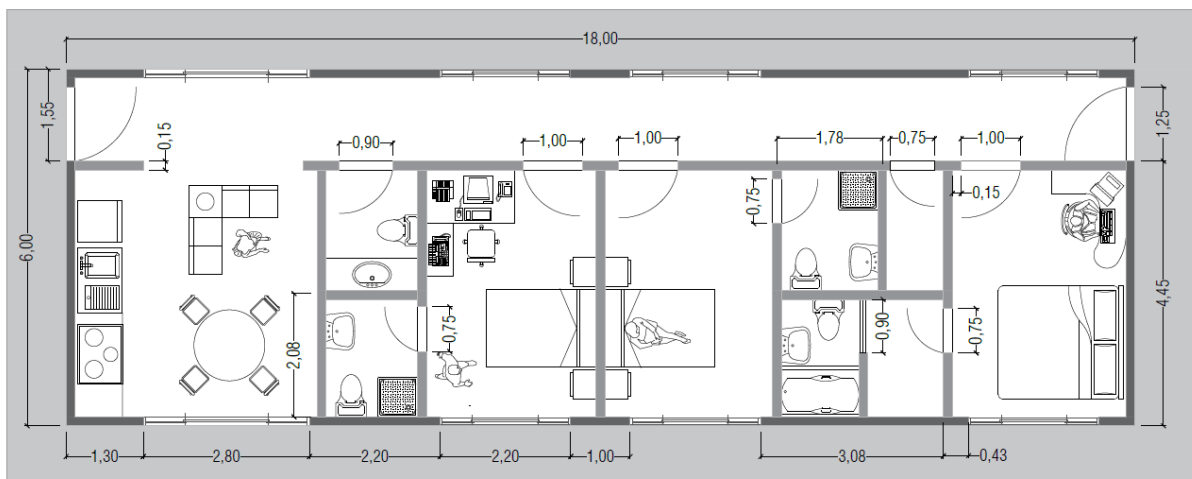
Vista en planta del plano arquitectónico de la vivienda modelo.
